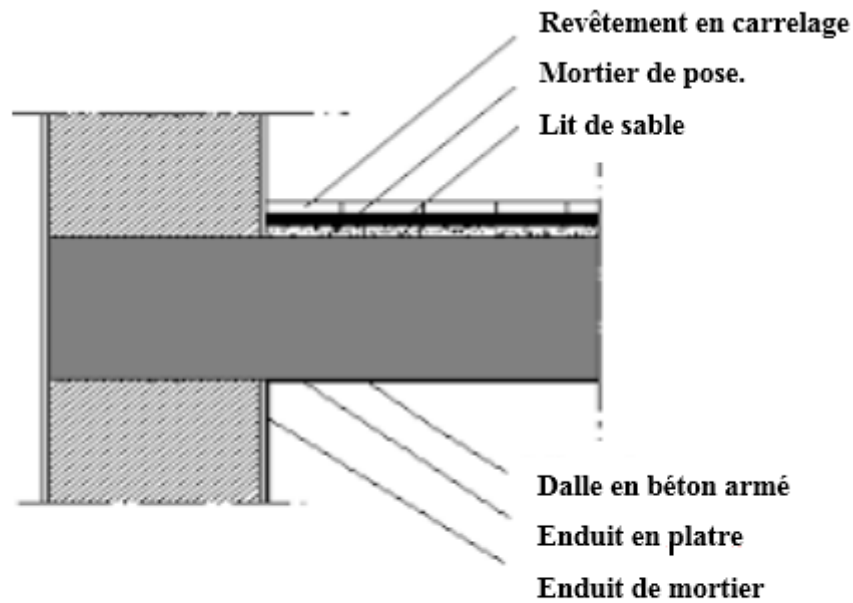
Composants d'un plancher étage courant en dalle pleine.
